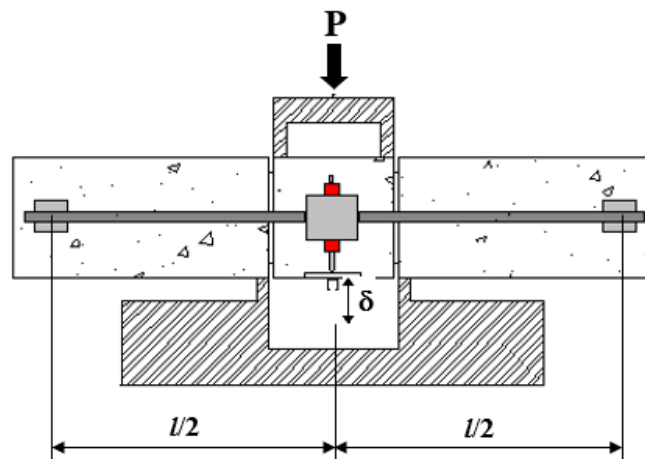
Configuración del ensayo propuesto por la recomendación japonesa SF-6.
